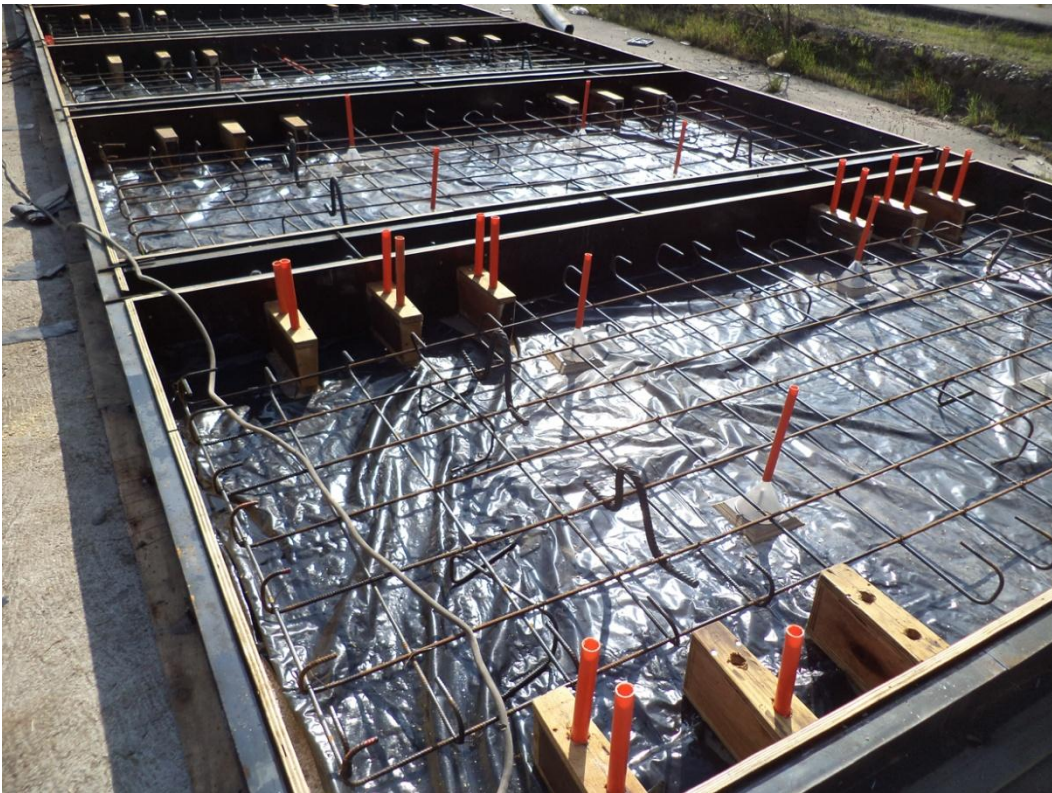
Colocación de polietileno en la base, armadura y tubos para la inyección de grout.
